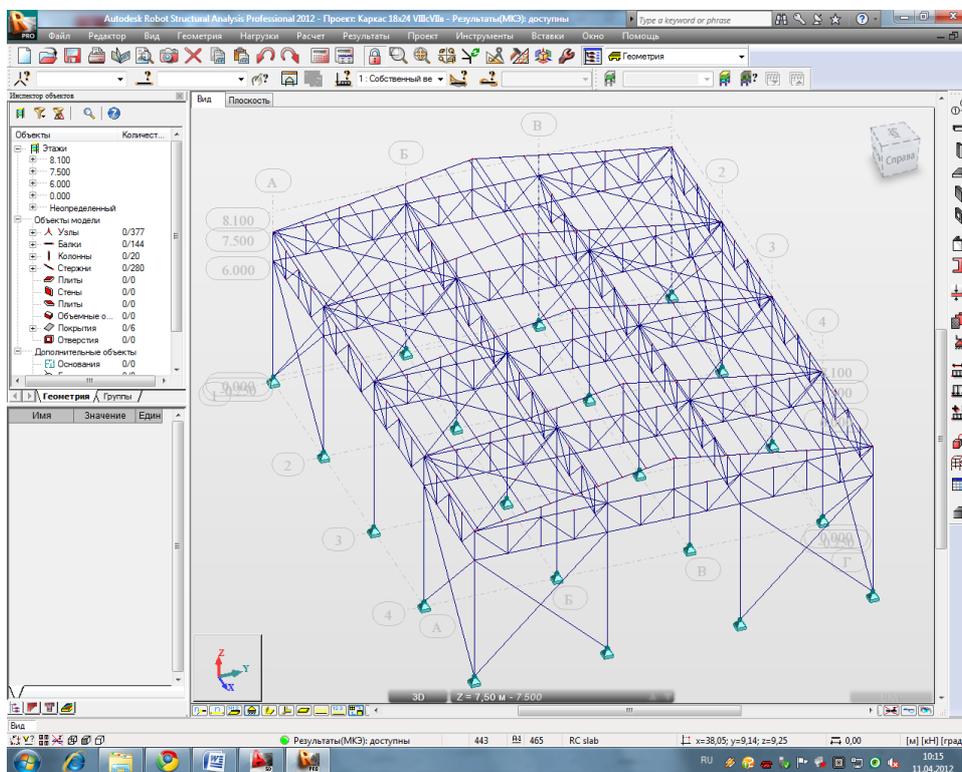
Общий вид расчетной схемы каркаса котельной в Robot Structural Analysis.
